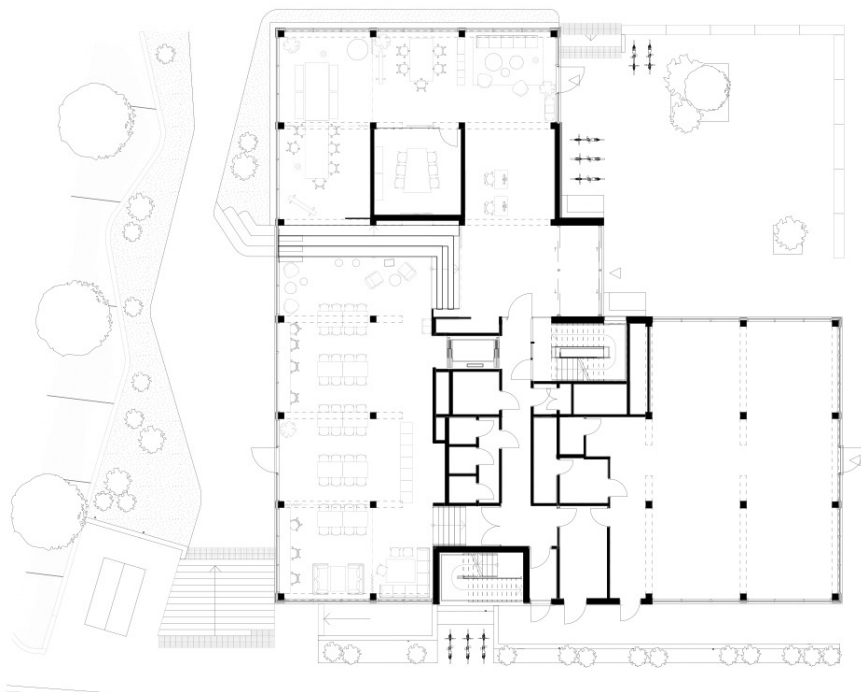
Plan Erdgeschoss – Foto: Oslotre
